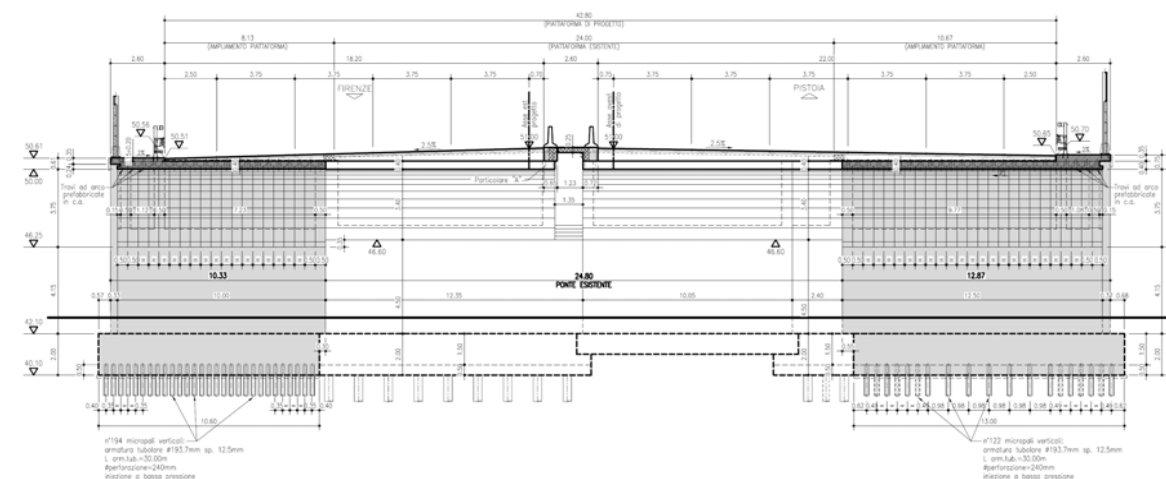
Sezione trasversale dell'impalcato allargato
